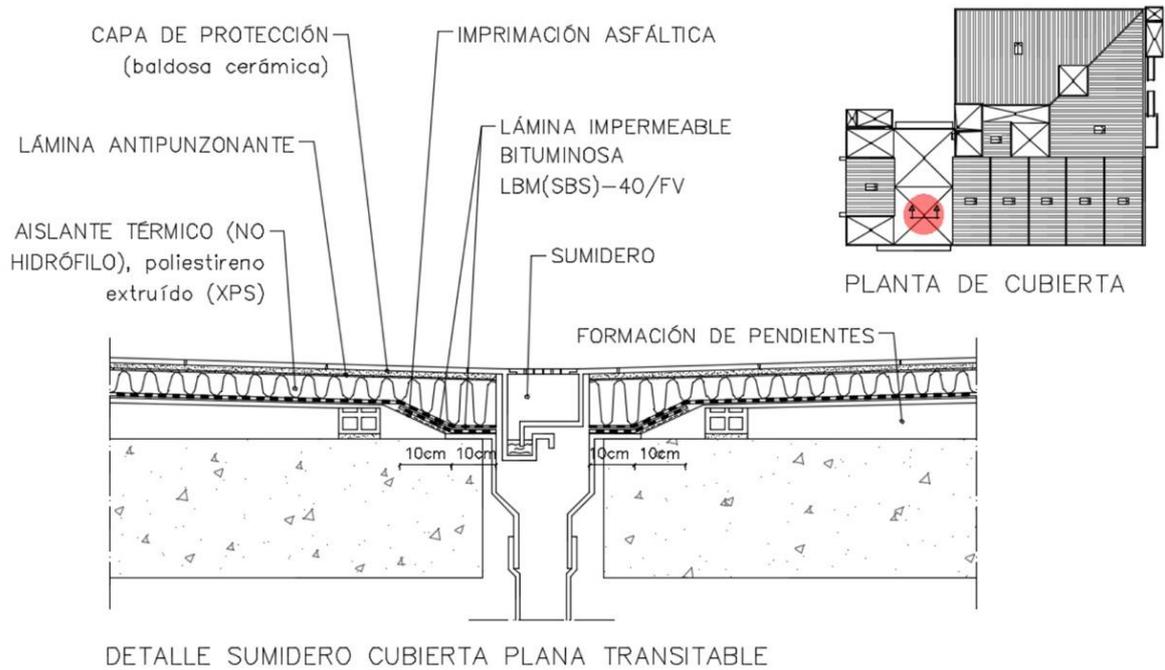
Esquema de cubierta plana invertida transitable, en su encuentro con sumidero. Fuente: elaboración propia
